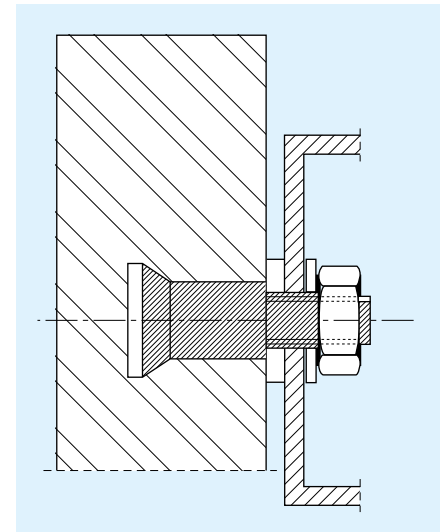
Nicht sichtbare Befestigung in den Bekleidungsplatten mit Hinterschnittdübeln
